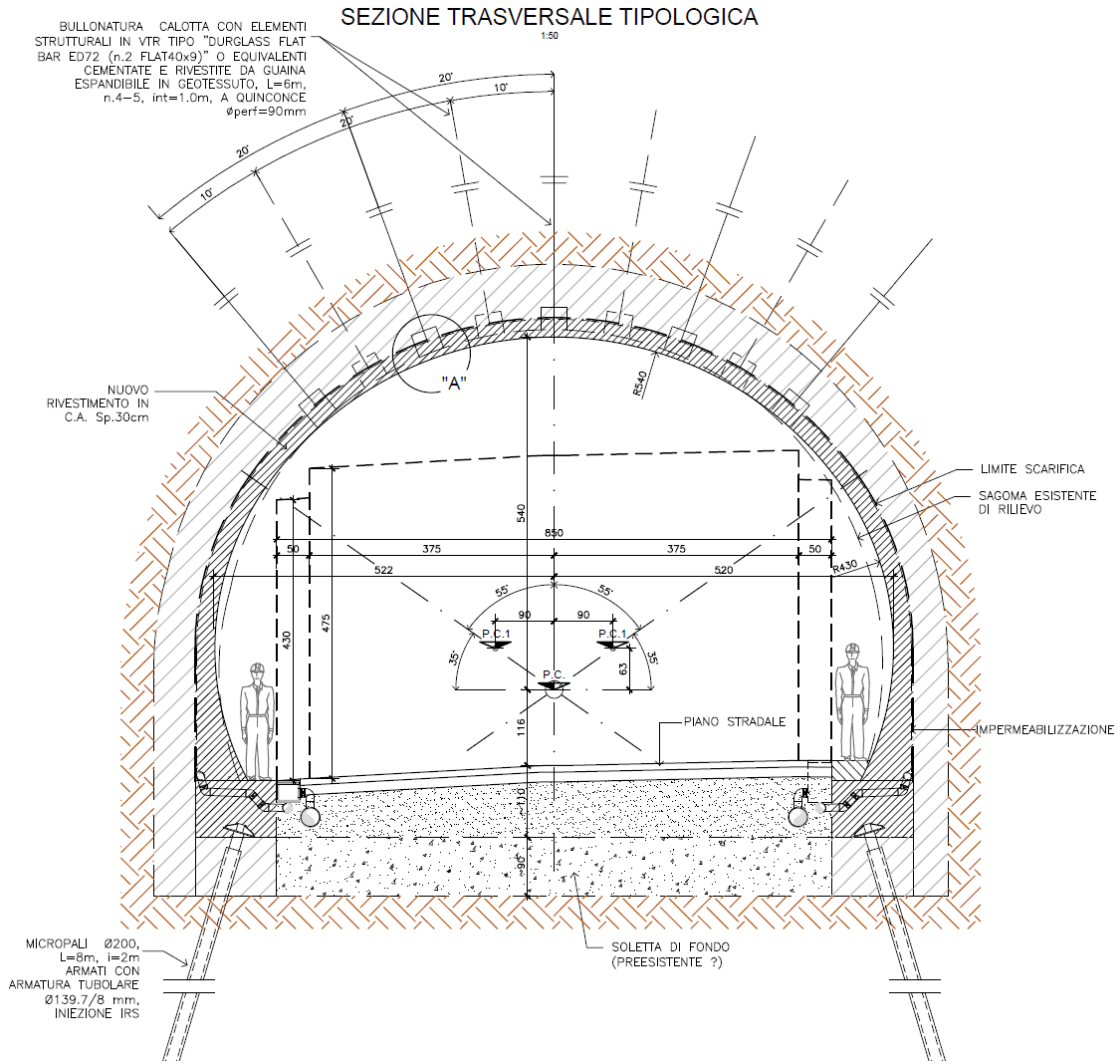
Sezione trasversale tipologica dell'intervento di risanamento in progetto
